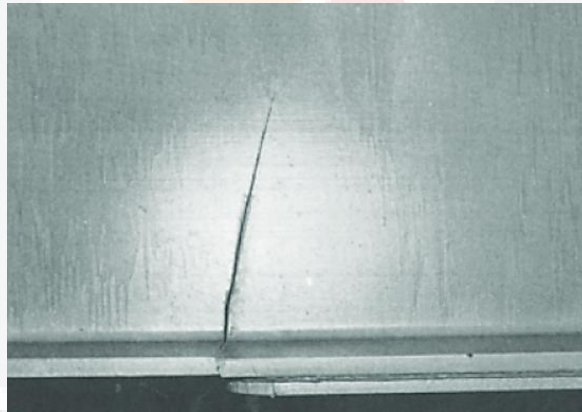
Falla por fatiga en trabe de acero del puente Yellow Mill Pond, Connecticut, E.U.
